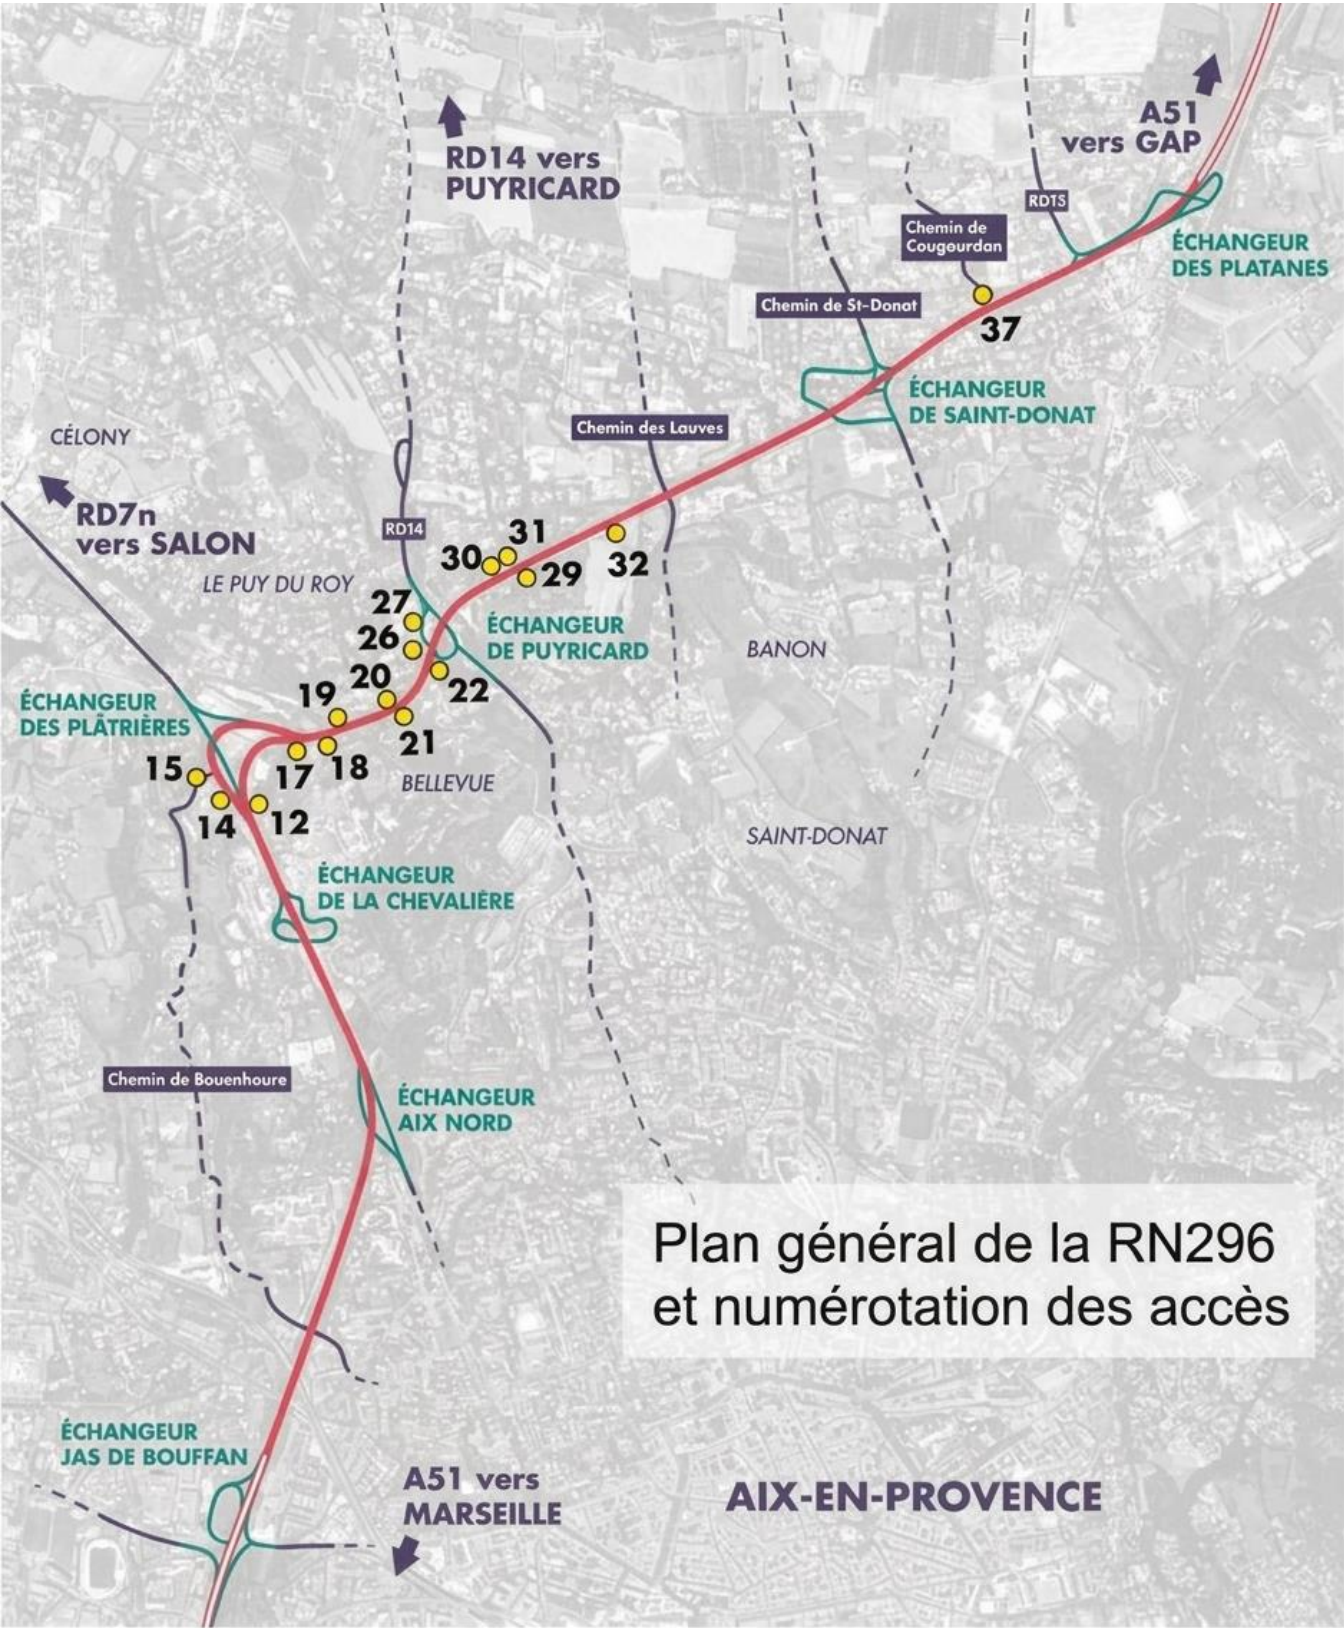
Plan d'implantation des accès à supprimer sur la RN296
